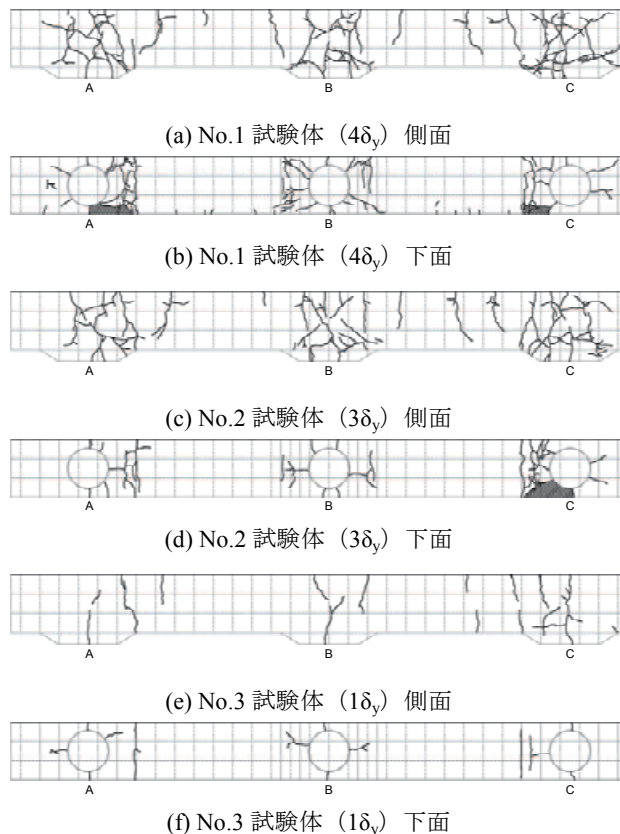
上部工のひび割れ図（正負交番載荷終了後）
